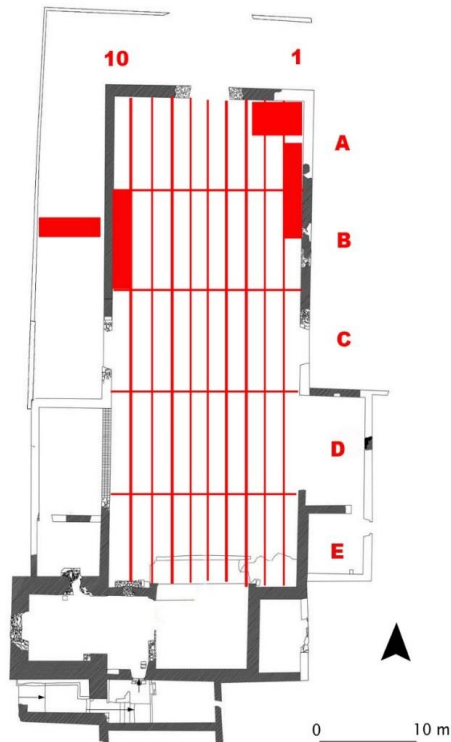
Plano de la Catedral con la cuadrícula establecida para la ubicación y registro, donde aparecen en color rojo las excavaciones con enterramientos en el atrio, y el interior de la nave (B10 y A1B1), además del área del presbiterio (A1-2 y 3), en la esquina noreste.
